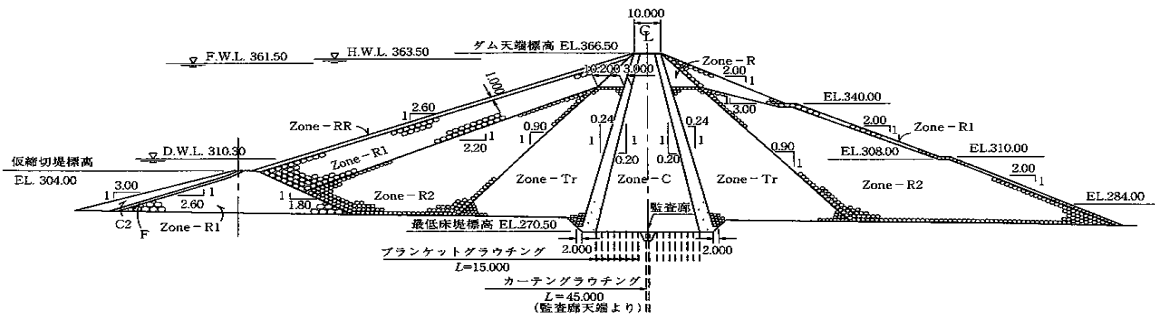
中心遮水ゾーン型フィルダムの事例（新鶴子ダム）
